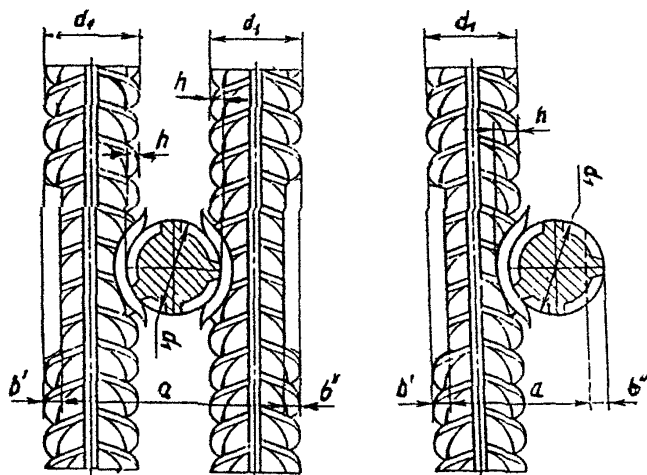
Схема крестообразных соединений, выполняемых контактной точечной сварки
